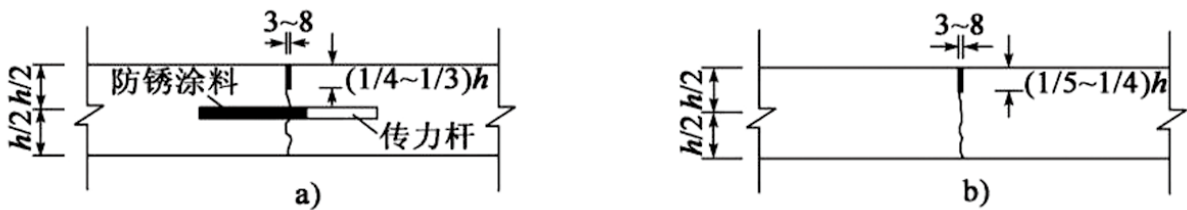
横向施工缝构造 (尺寸单位: mm)
